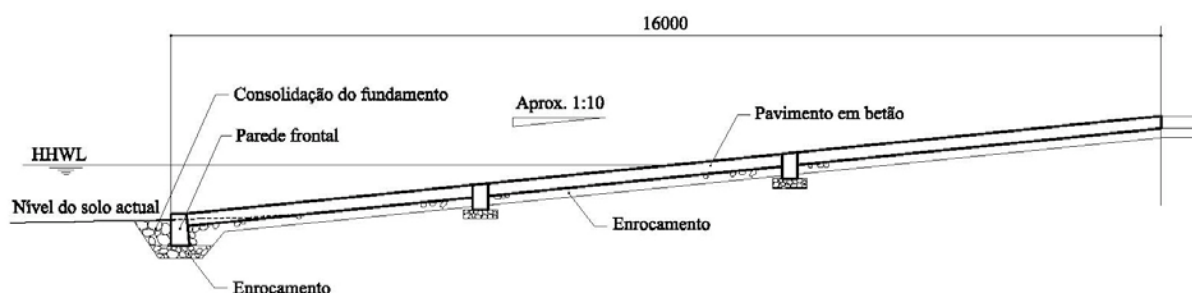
Plano de Corte Transversal da Área de Elevação de Embarcações
